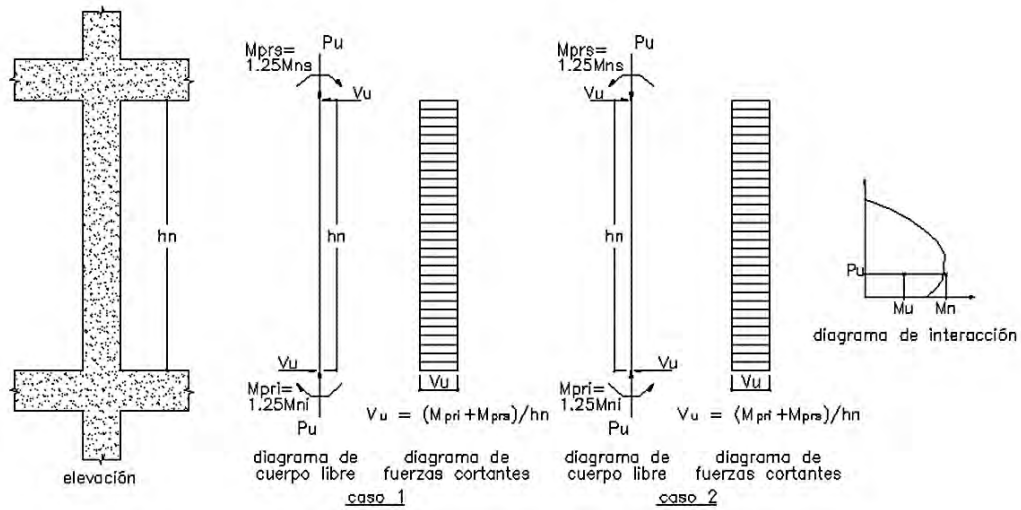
Esquema del cálculo de fuerza cortante en columnas aporticadas [8]
